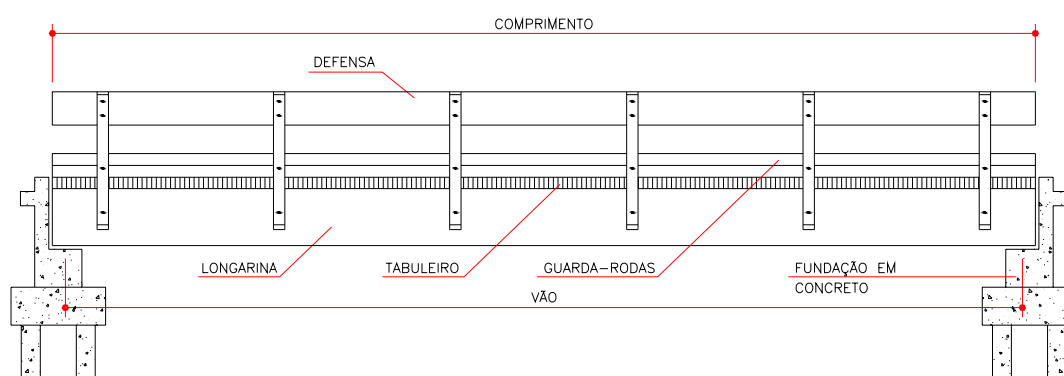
Vista lateral da ponte em vigas de MLC
